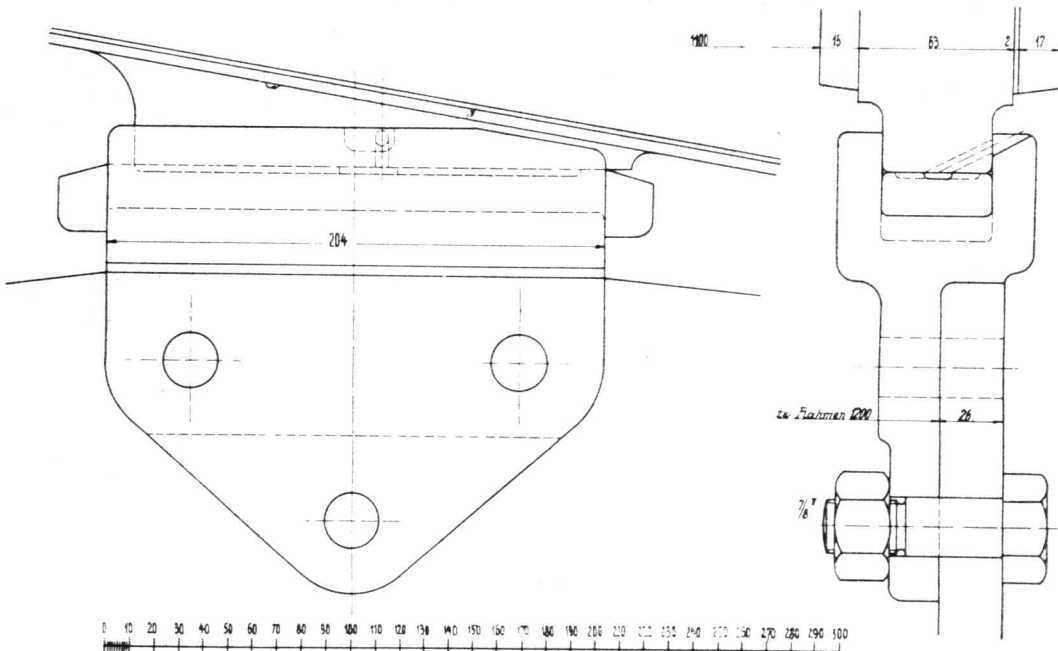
Boxgleitstütze seitlich am Mantelring.
